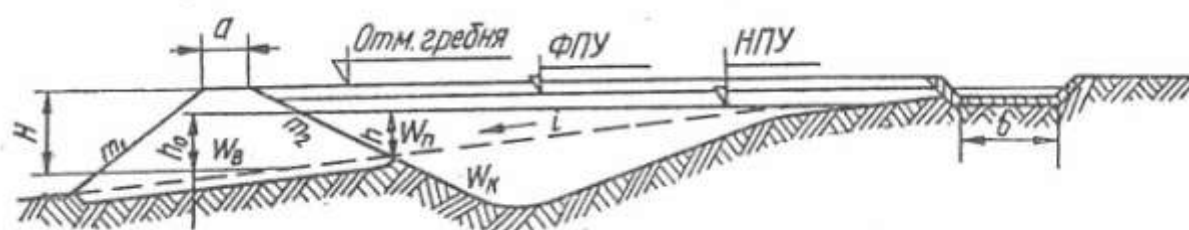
Принципиальная схема поперечного сечения вала
